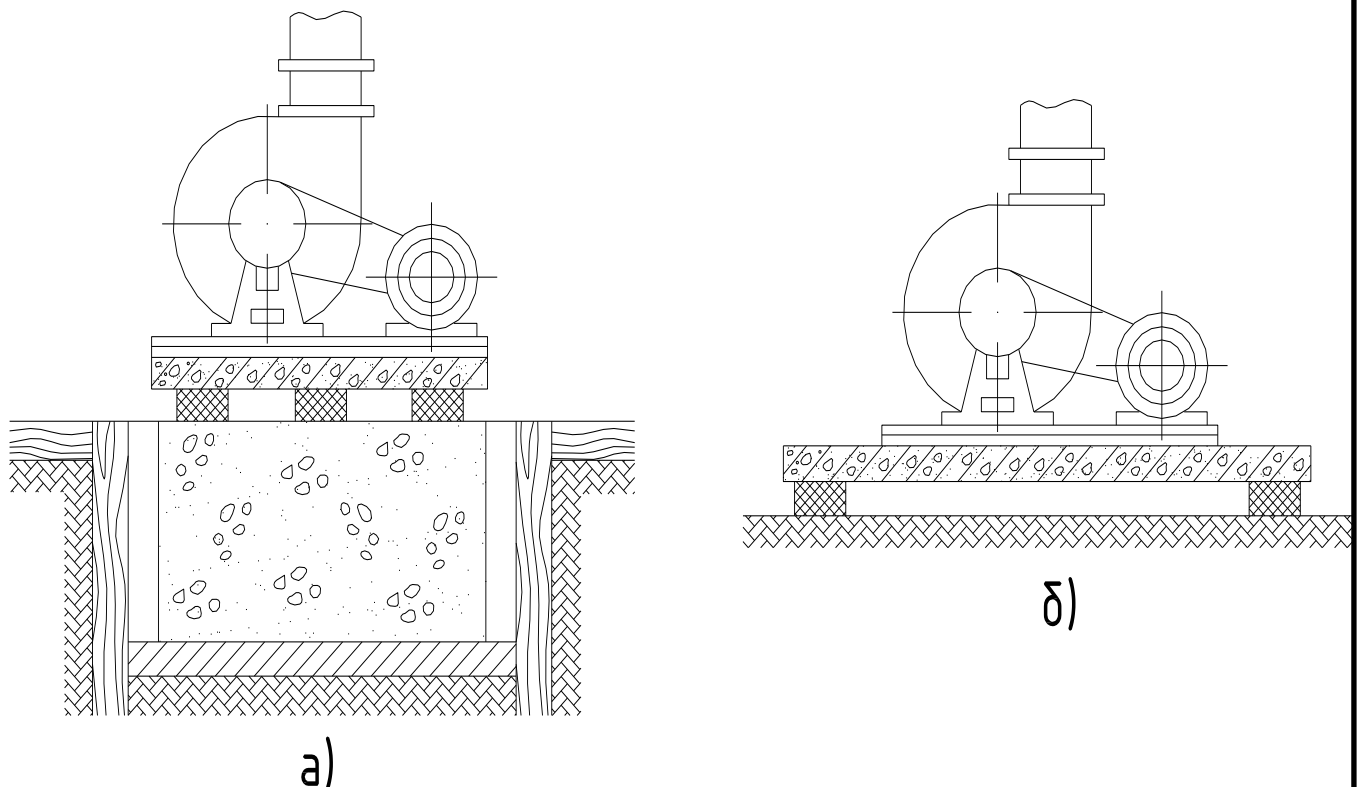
Схеми встановлення агрегатів: а) на фундаменті і ґрунті; б) на перекритті
